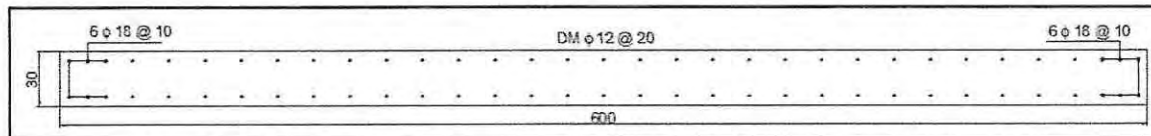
Armadura de flexo-compresión Muro 1, Estructura VI (Aislada).
